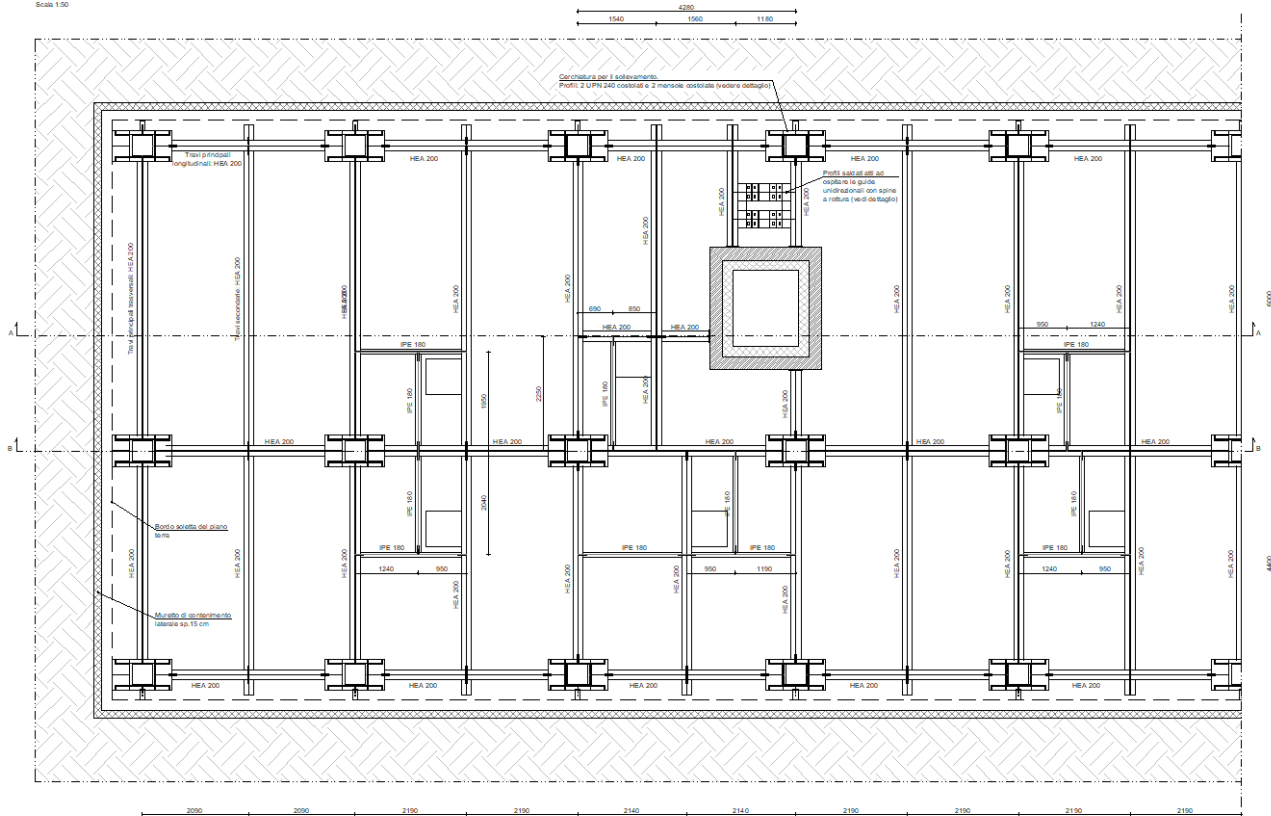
Carpenterie in acciaio del nuovo solaio al piano terra.
